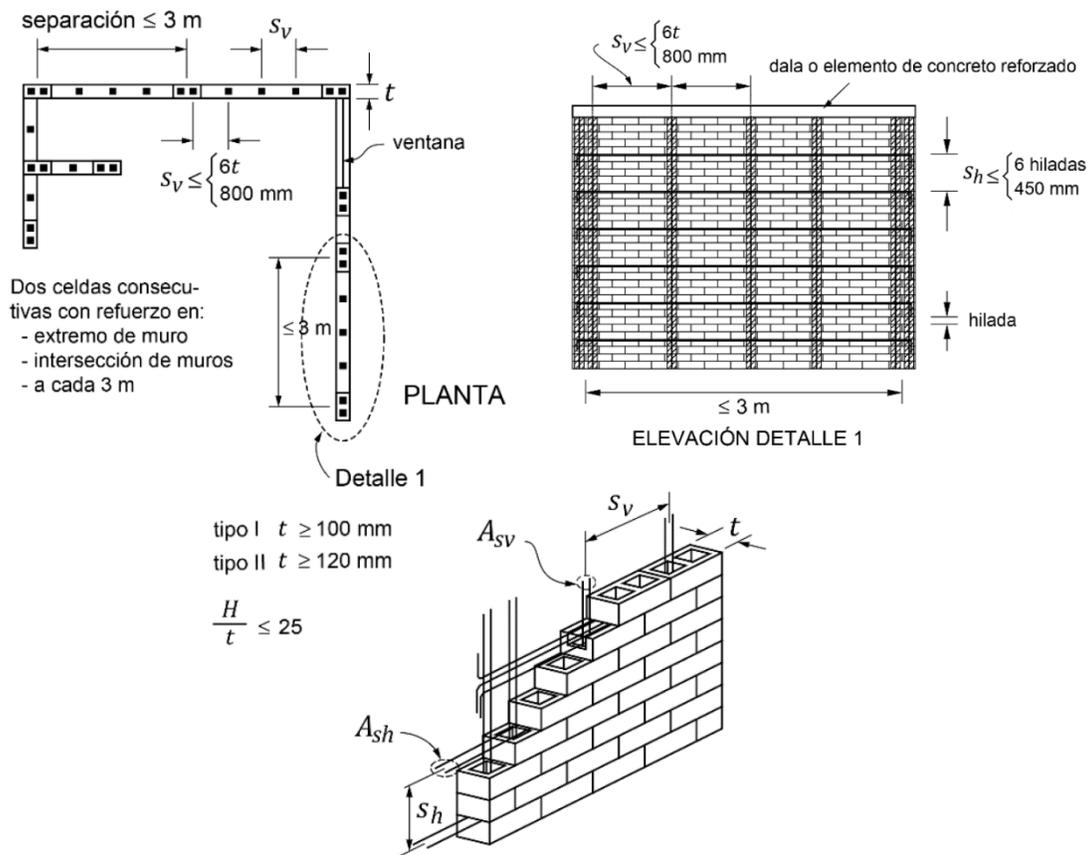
4 Requisitos para mampostería con refuerzo interior.
